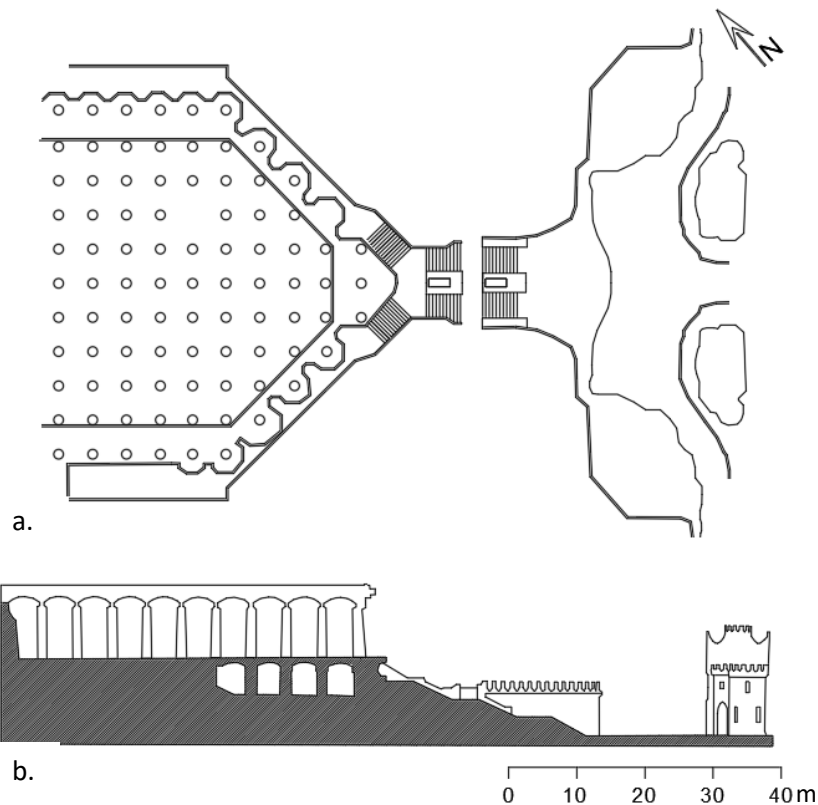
a) Planta de la sala hipóstila en la que puede verse la posición de las columnas. b) Sección de la sala hipóstila. La forma de la sección se adapta a la topografía del terreno y deja un espacio para la sala de almacenamiento de agua.
